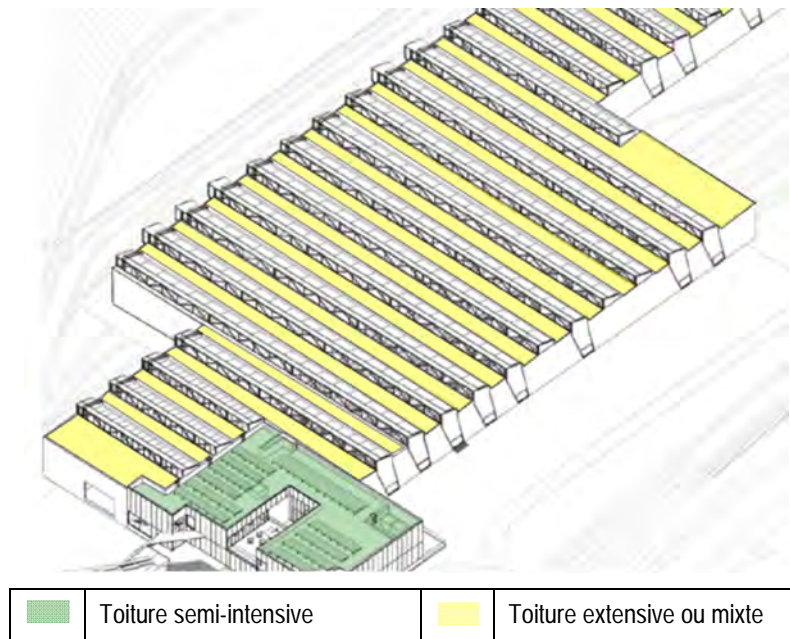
Recommandation de mise en place de toitures végétalisées extensives sur le bâtiment atelier/remisage et toitures semi-intensives sur le bâtiment administratif (ARIES, 2020, sur fond BMN, 2018)
